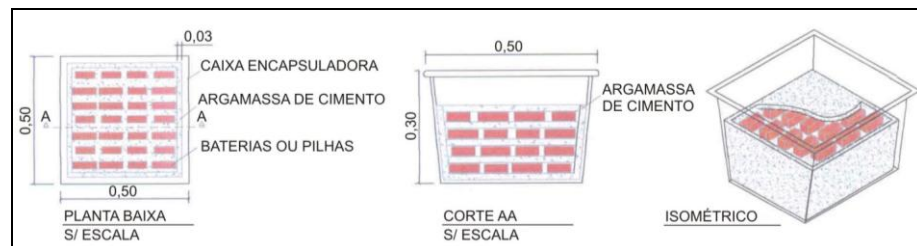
Encapsulamento de Baterias e Pilhas
